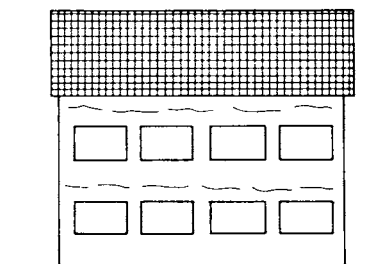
Образование горизонтальных трещин на фасаде из-за прогиба балочного перекрытия
